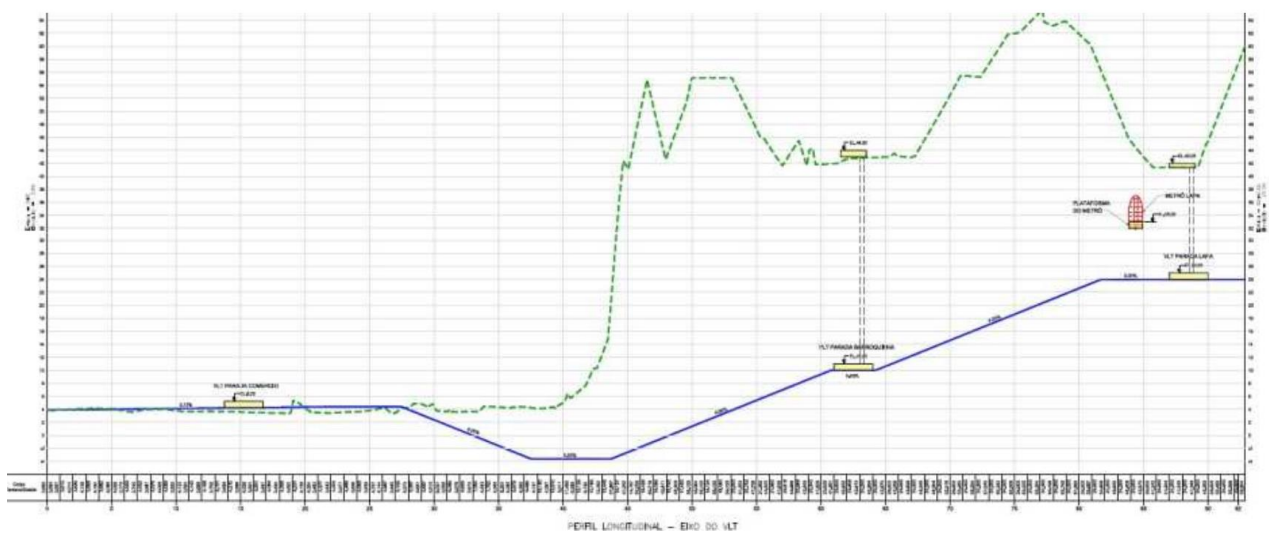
F CONEXÃO COMÉRCIO – BARROQUINHA – LAPA – PERFIL LONGITUDINAL<sup>15</sup>
